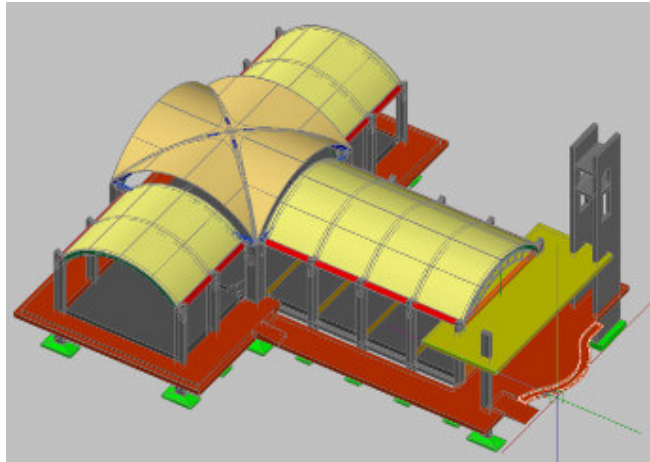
8 Vista Izquierda (Perspectiva llena) Fundación , Vigas , Tabiques , losa, Vigas de Borde ,Arcos y Cubierta
